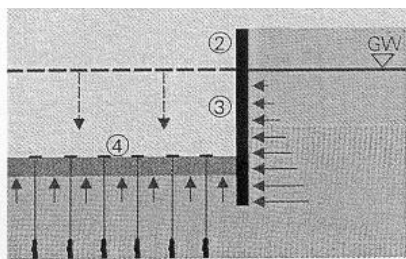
Dichte Baugrube mit Unterwasserbetonsohle [Eisele 2002, S. 87]
